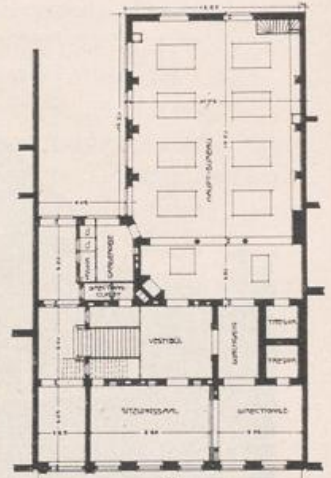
Breitestrasse 8. Erdgeschoss. 1:500.
